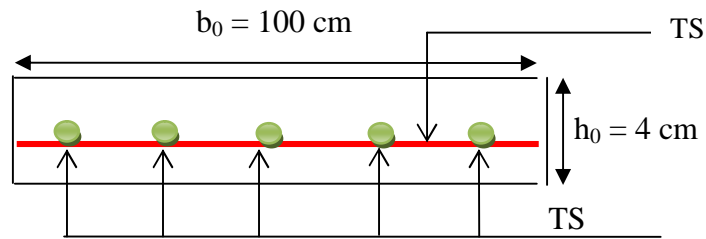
Schéma du ferrailage de la dalle de compression
